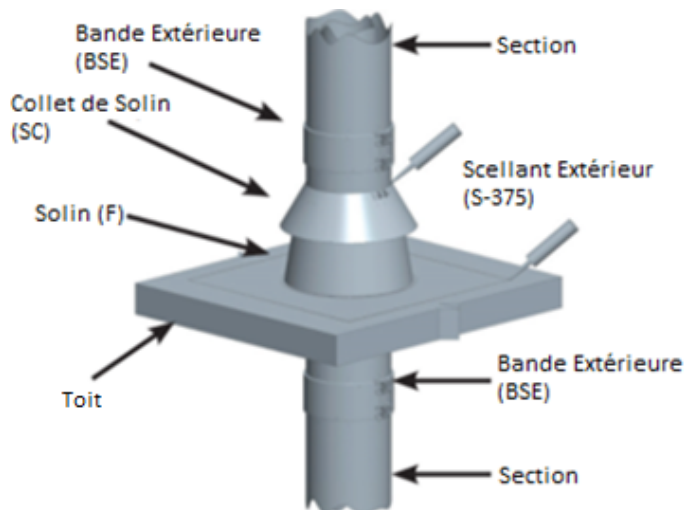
Installation du Solin (F) - Vue du haut du toit
